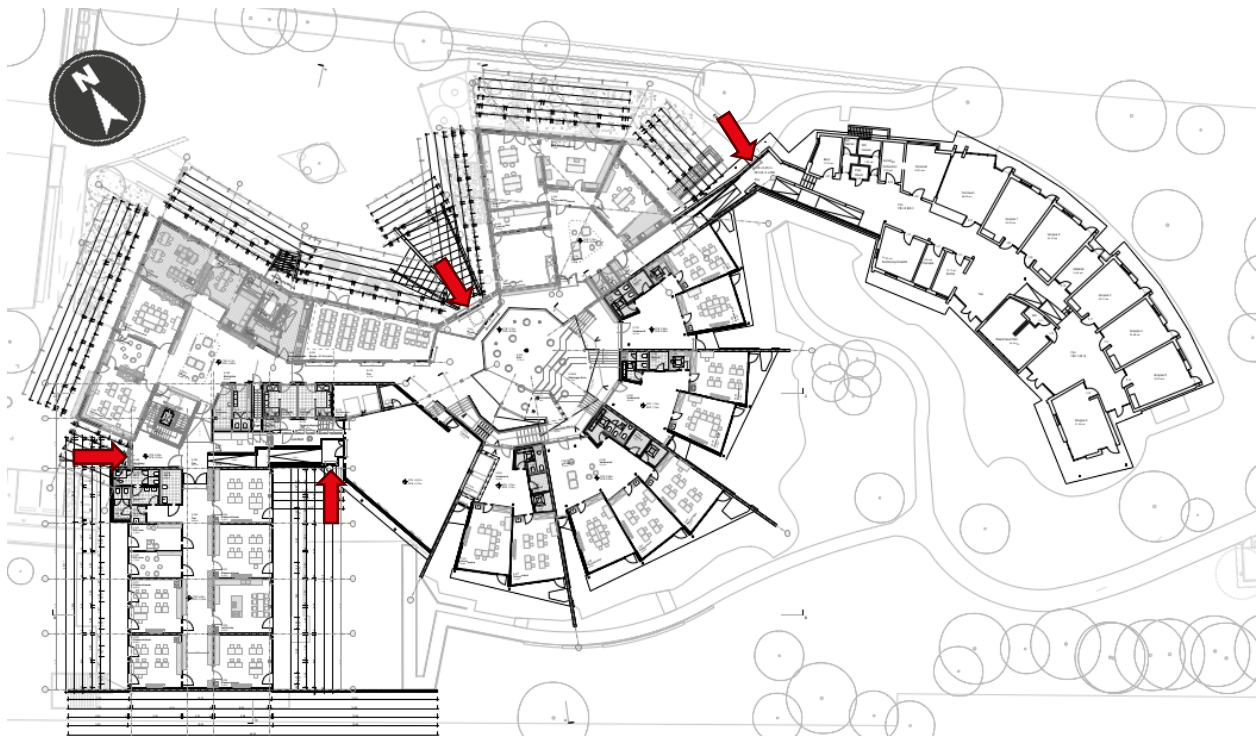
| Grundriss Erdgeschoss [Quelle: Herrmann+Bosch Architekten]
